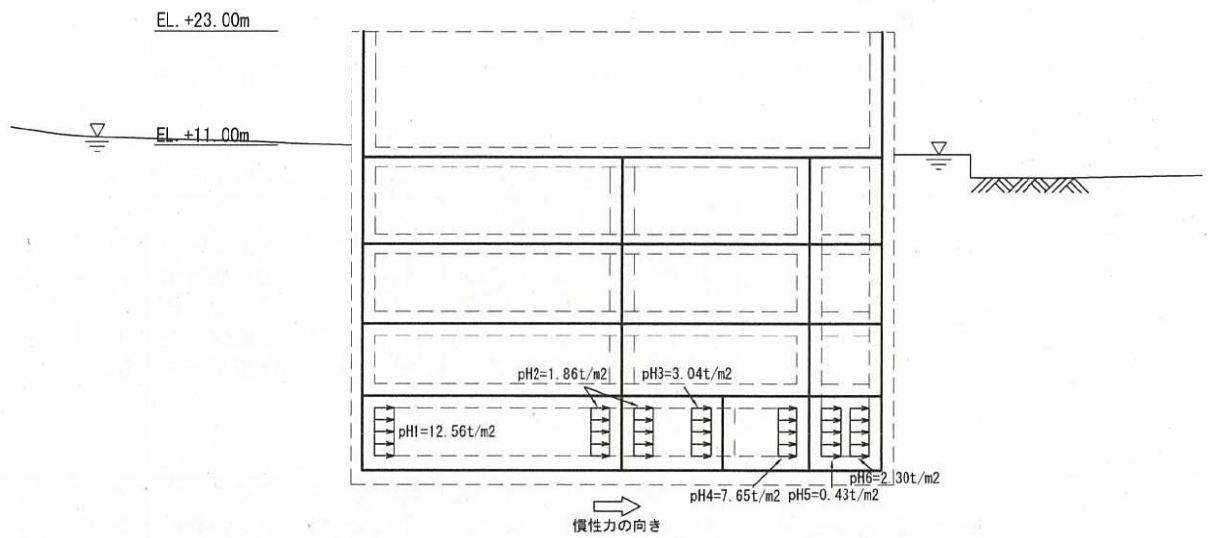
(3) 水平動による動水圧図 (東西方向断面)
